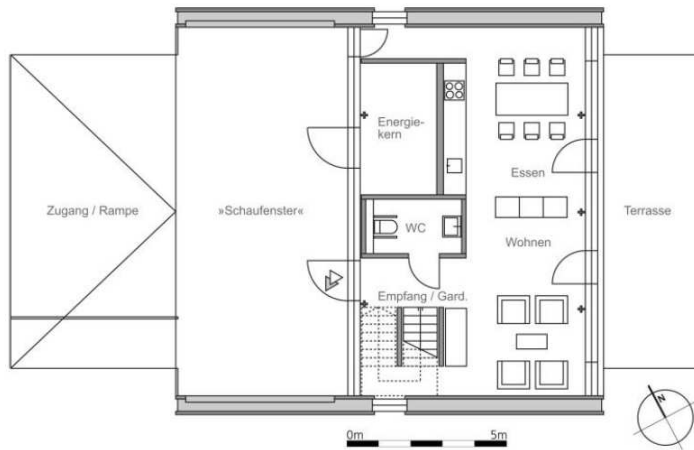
Grundriss EG (Quelle: IBP 2013, S.5)
